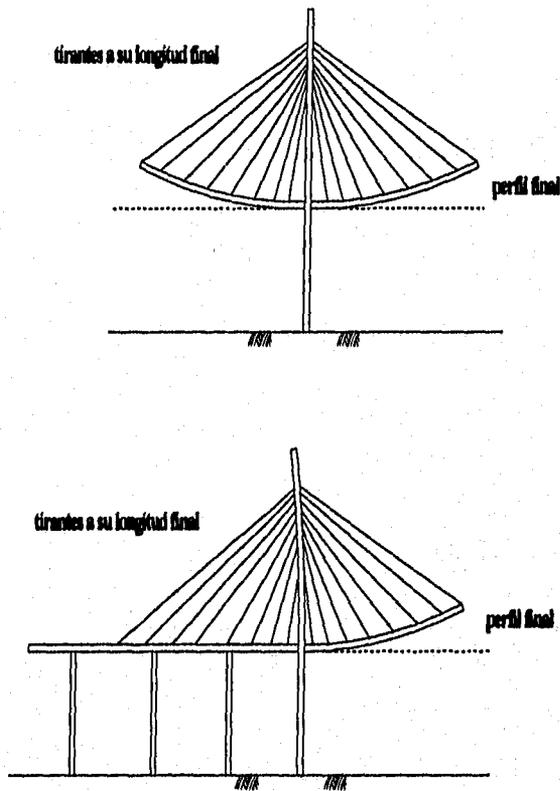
Construcción de puentes atirantados con la longitud final de los tirantes:
